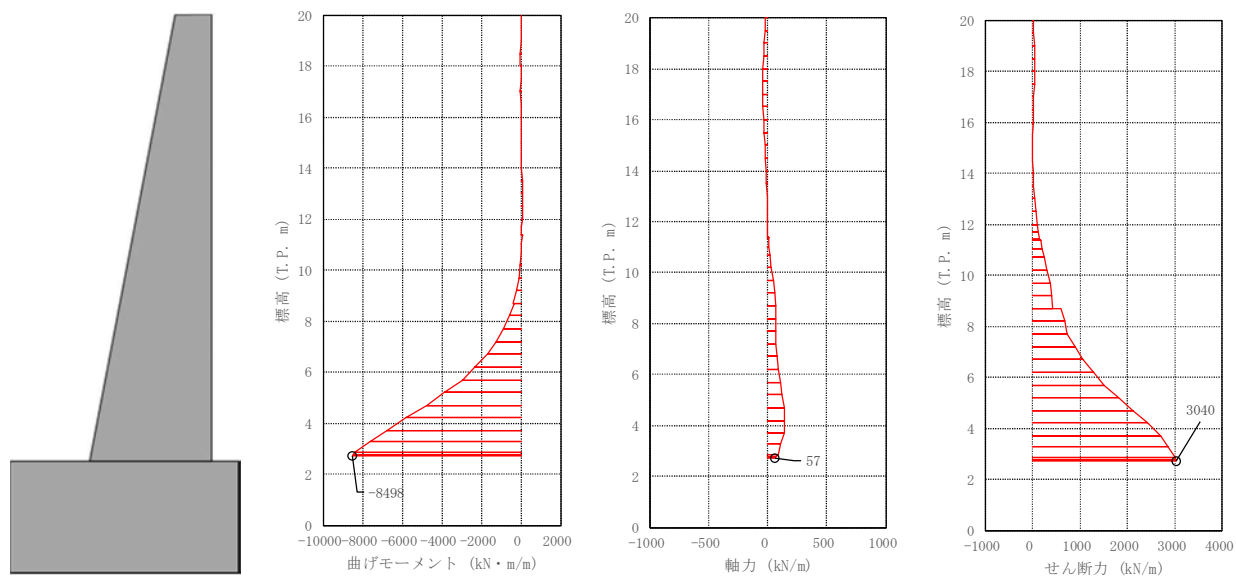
(1) 鉄筋コンクリート防潮壁においてせん断力照査結果が最も厳しい断面力
